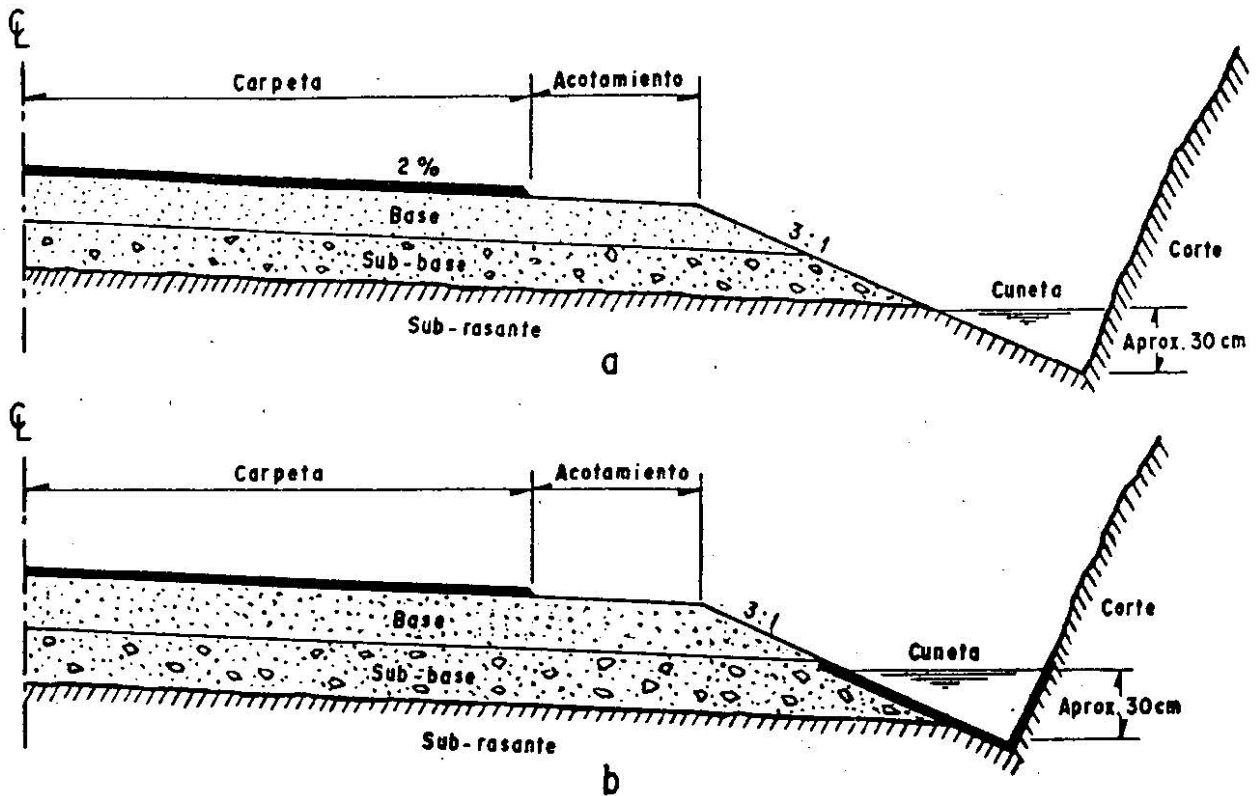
Disposición más conveniente de la cuneta, respecto al pavimento. Sección en corte, sin subdrenaje.
